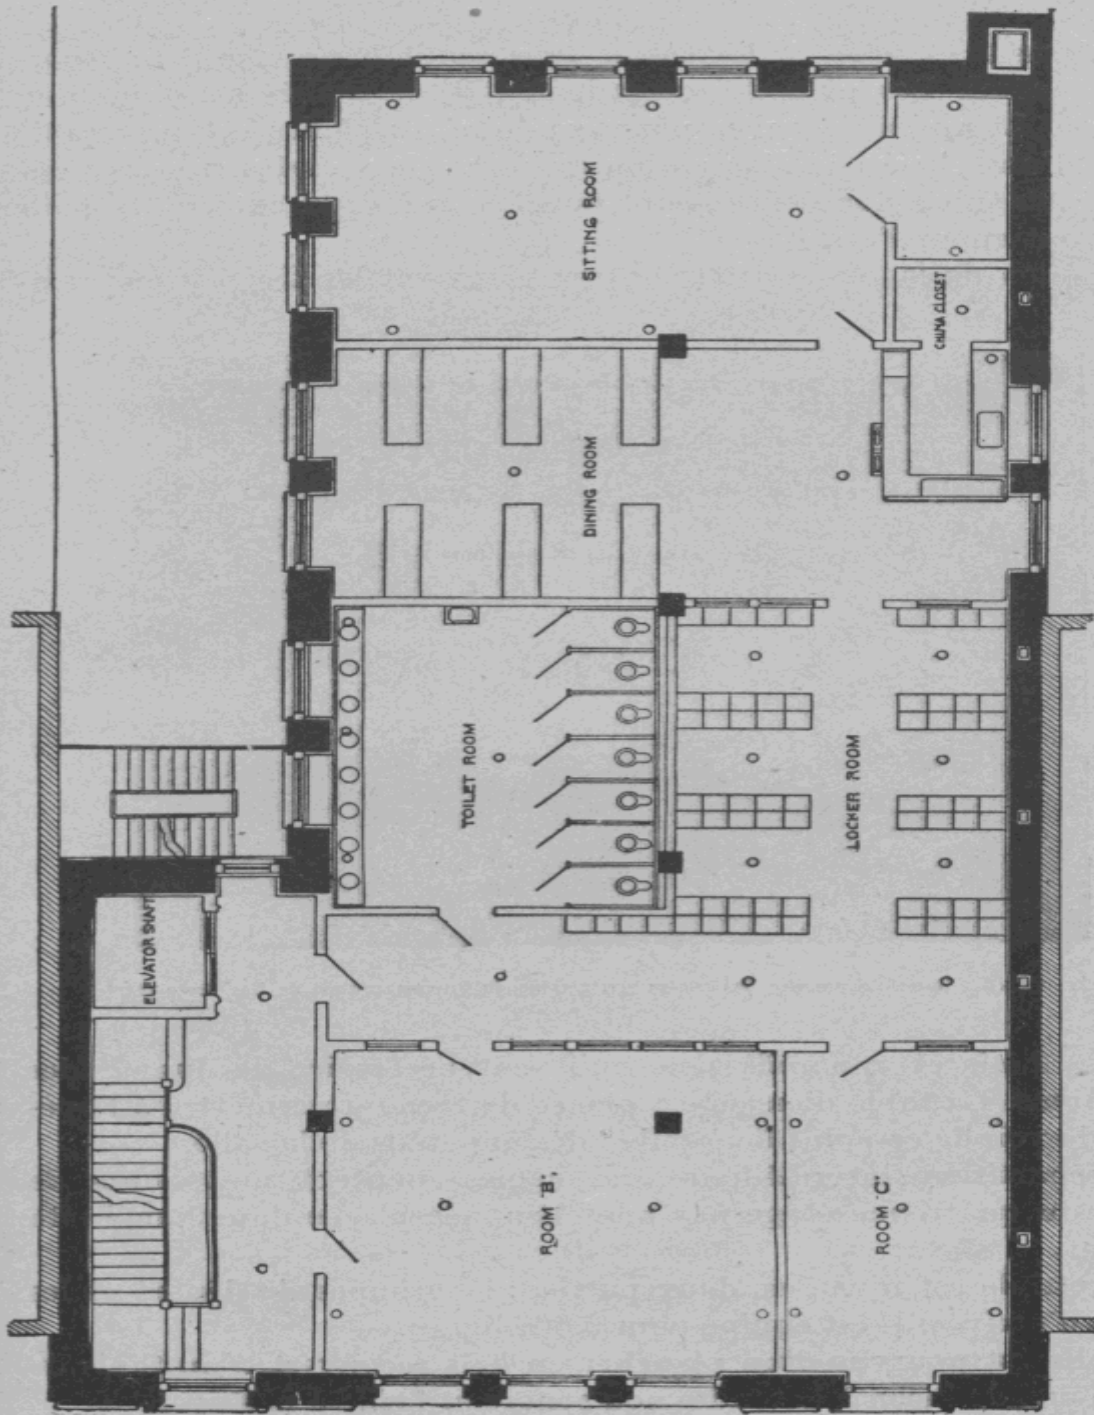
Plan du 3^e étage du bureau de Plaza.
